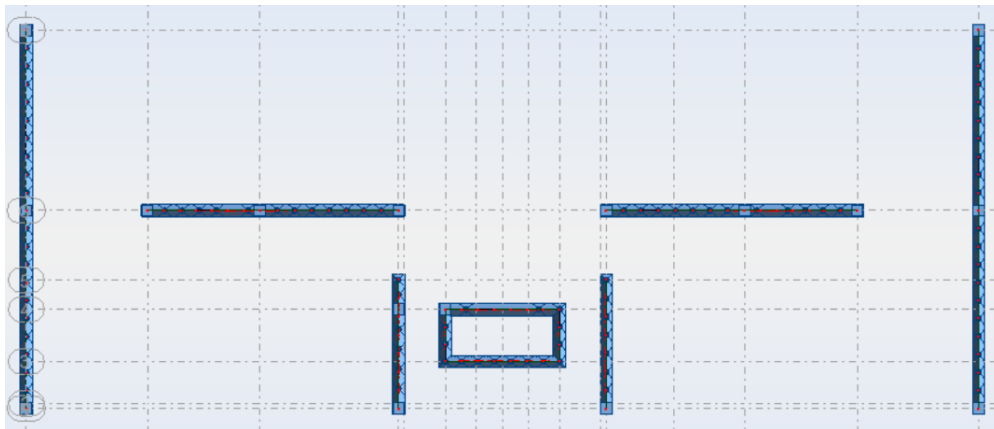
La 3^{ème} disposition des murs voiles et poteaux
